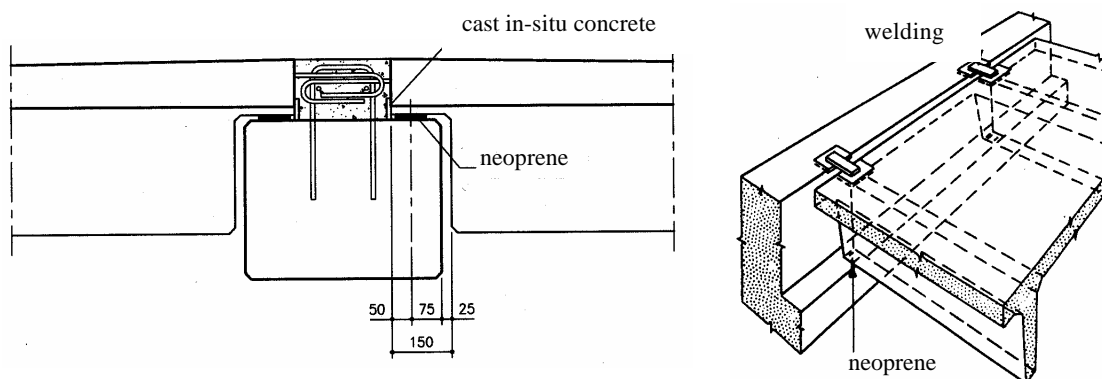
Ligações de apoio para elementos em duplo-T
